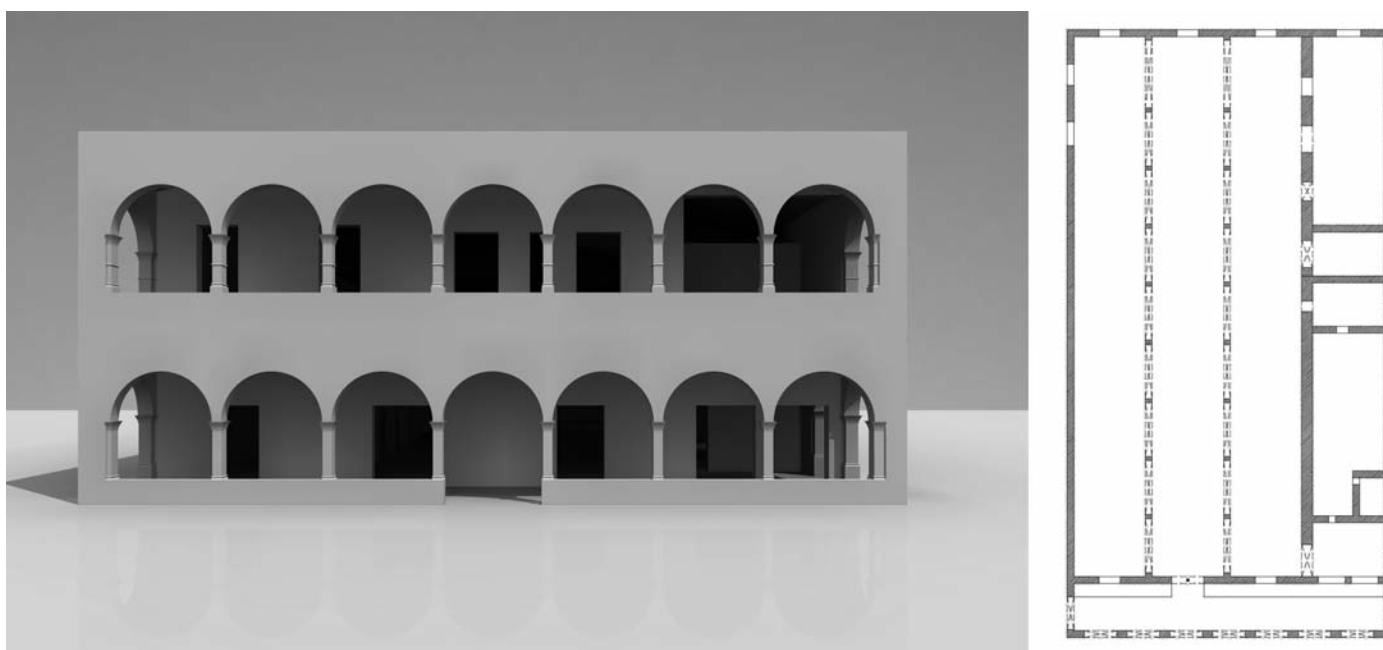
Ricostruzione ipotetica della casa da Câmara di Setúbal (alzato e pianta del piano terra).
